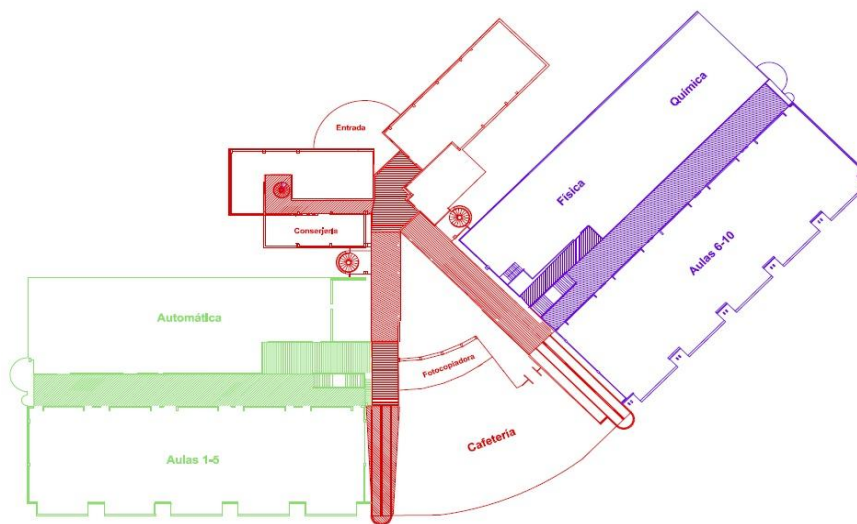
Distribución de zonas de iluminación. Edificio central planta baja.
